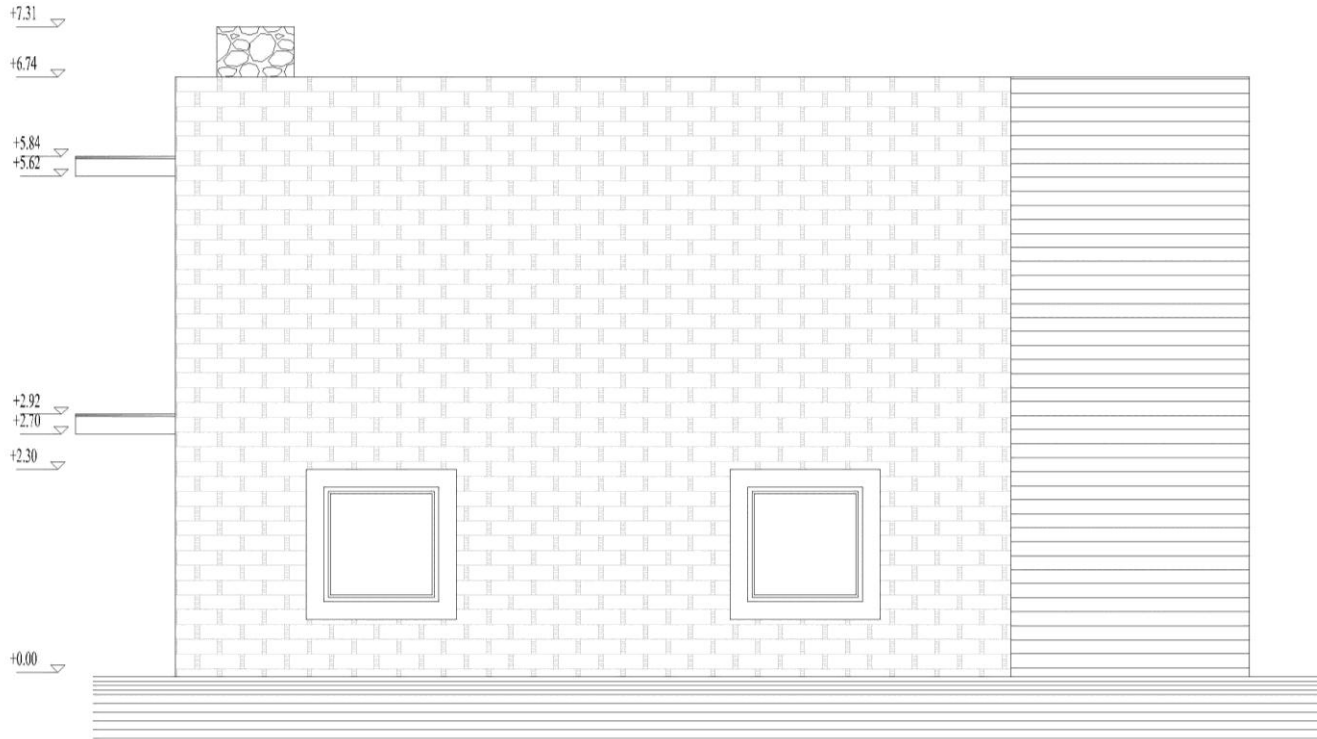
Betonarme sistem yapının arka cephe görünüşü
